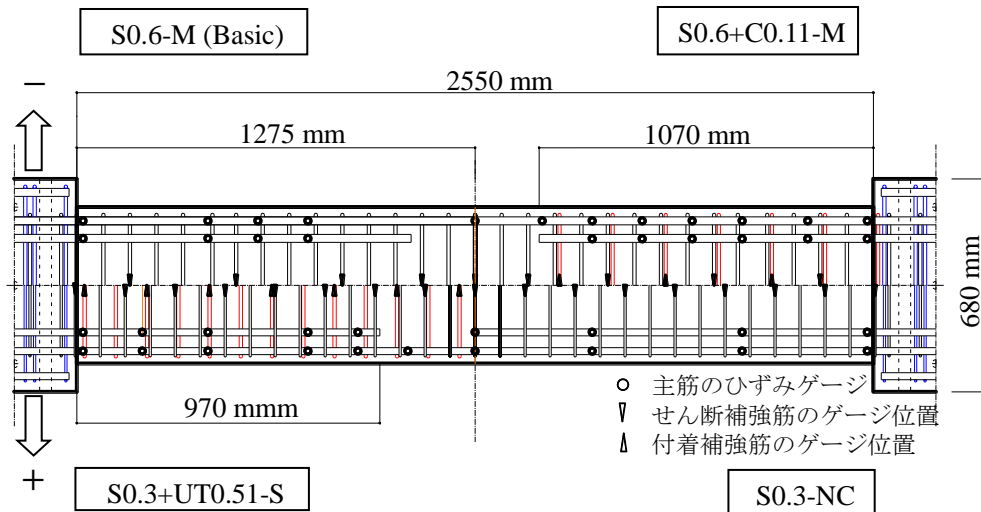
試験体配筋図とひずみゲージ位置
